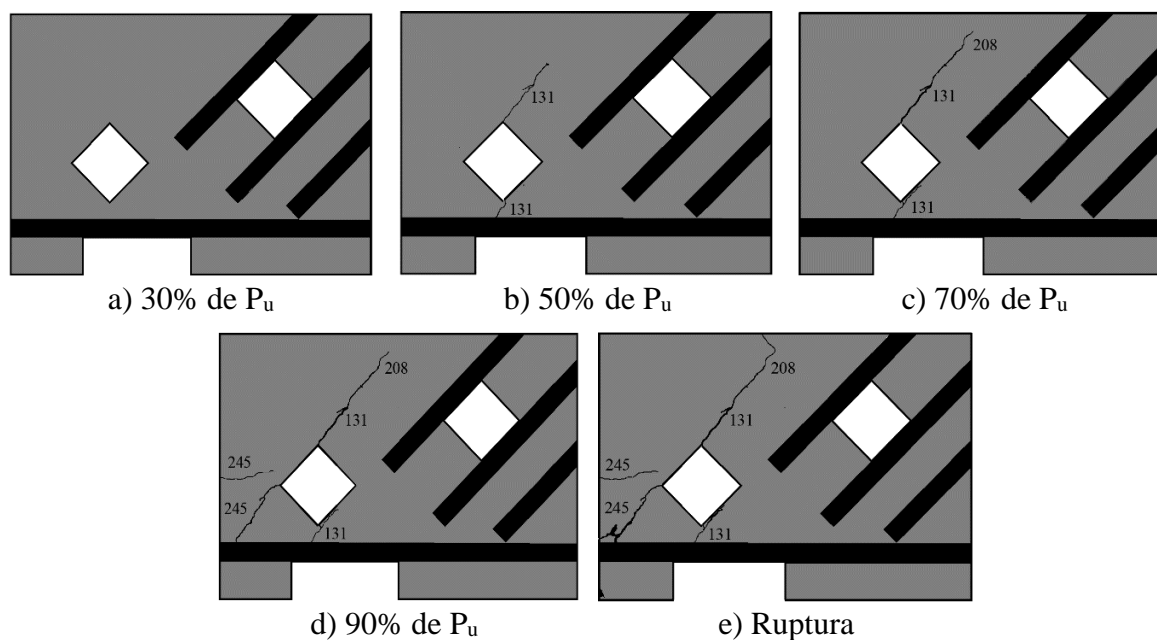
Mapa de fissuração DB3-H2-S-FS-1 (força indicada em kN)
